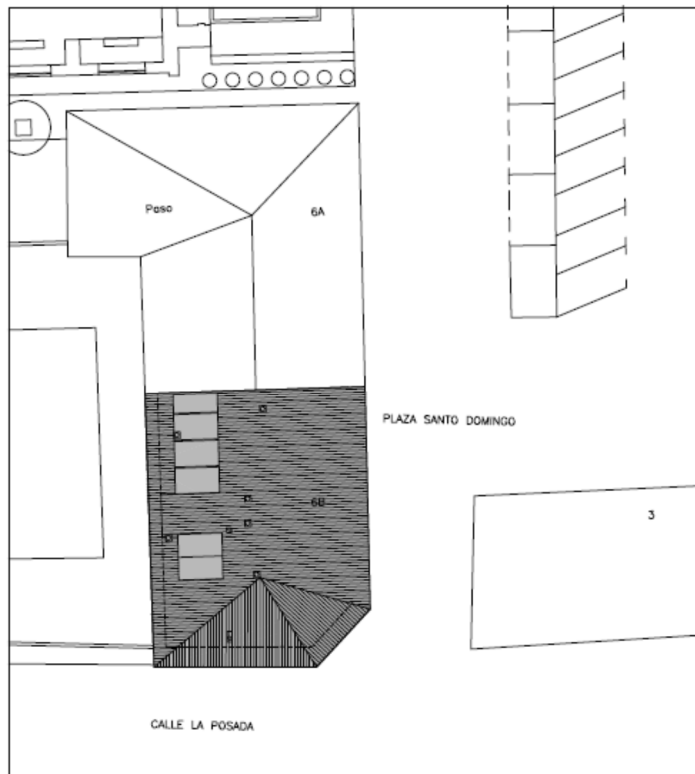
Plano emplazamiento edificio. Fuente: Elaboración propia
